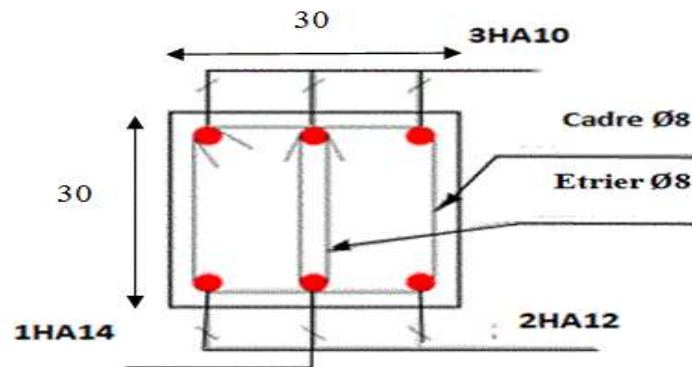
Schéma de ferrailage de la poutre de chaînage en appui et en travée
